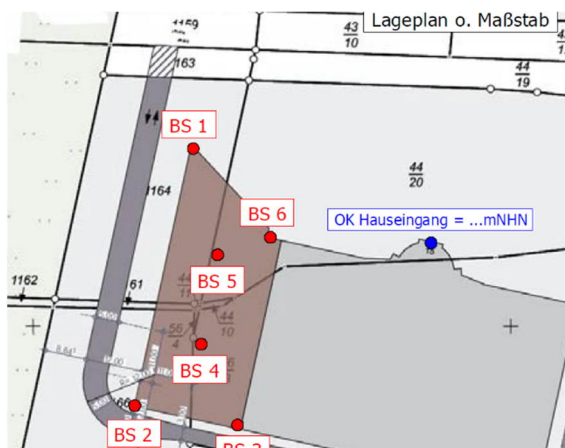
Lage der Bohrpunkte zur Baugrunduntersuchung
